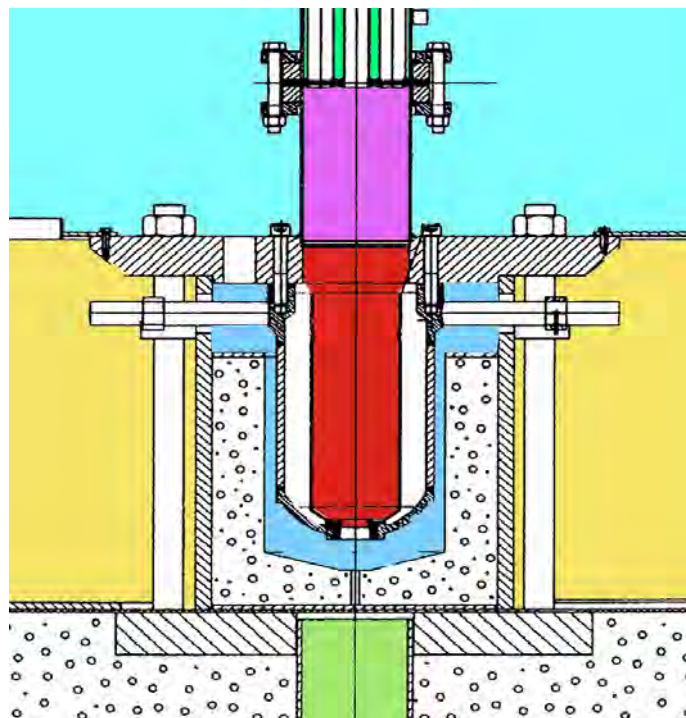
Detailvergrößerung des Bereichs Reaktorgrube.
